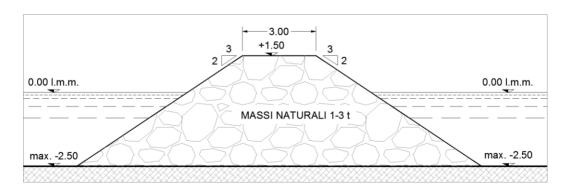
sezione tipo del pennello nella testata della parte emersa
